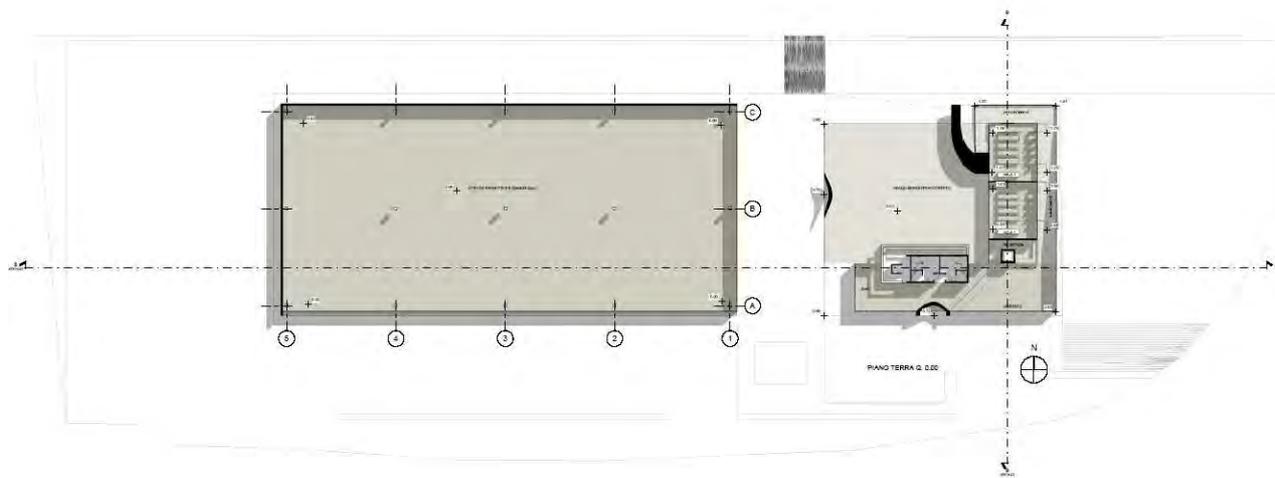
LOTTO A - PIANTA PIANO TERRA
